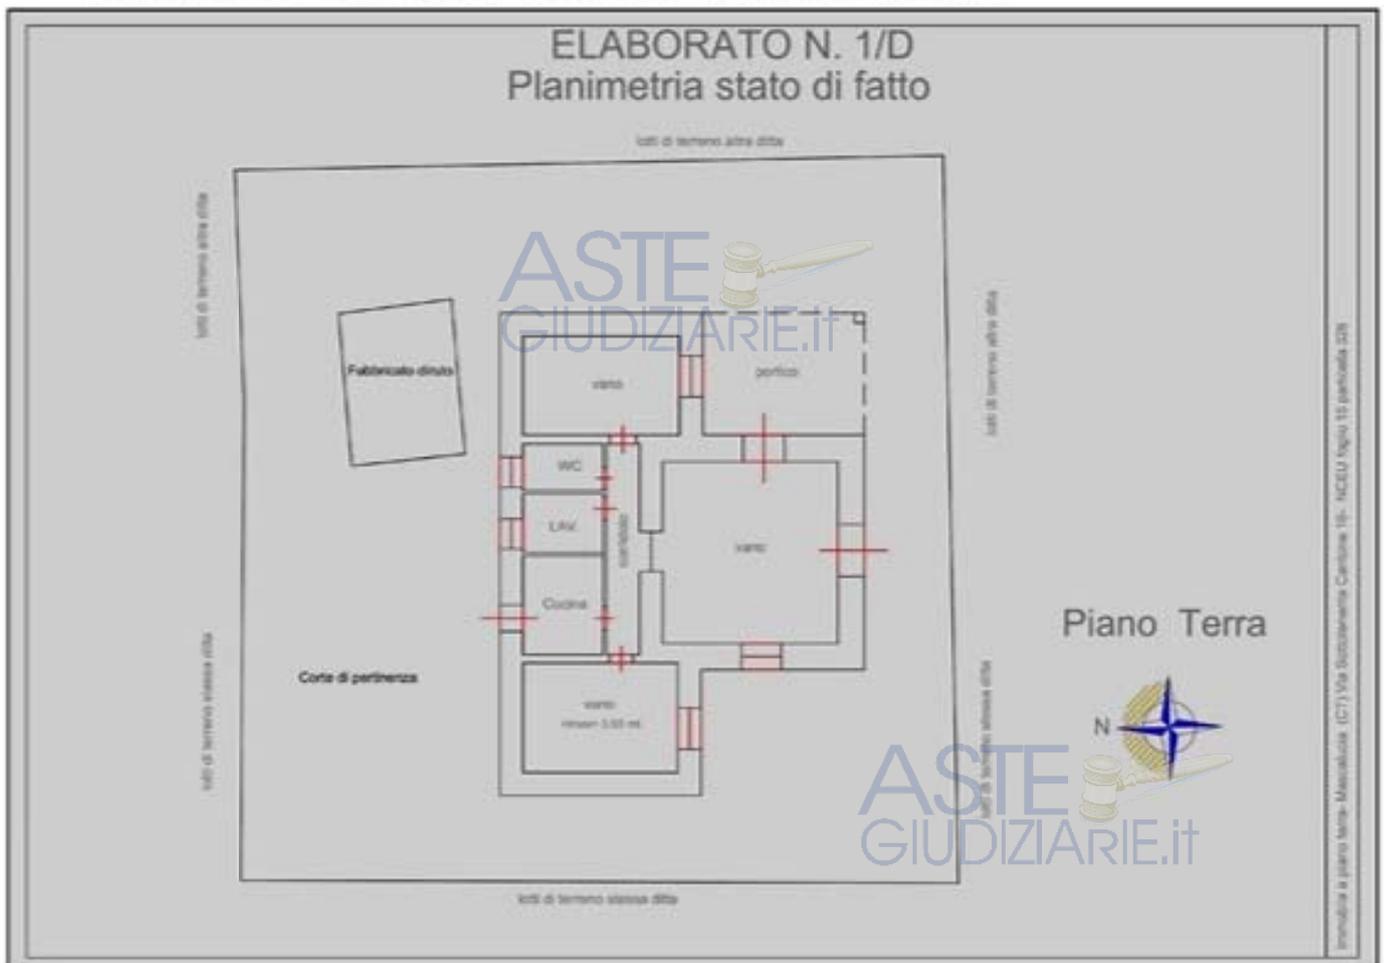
Visualizzazione della planimetria reale degli immobili ed individuazione della loro corte a giardinetto
